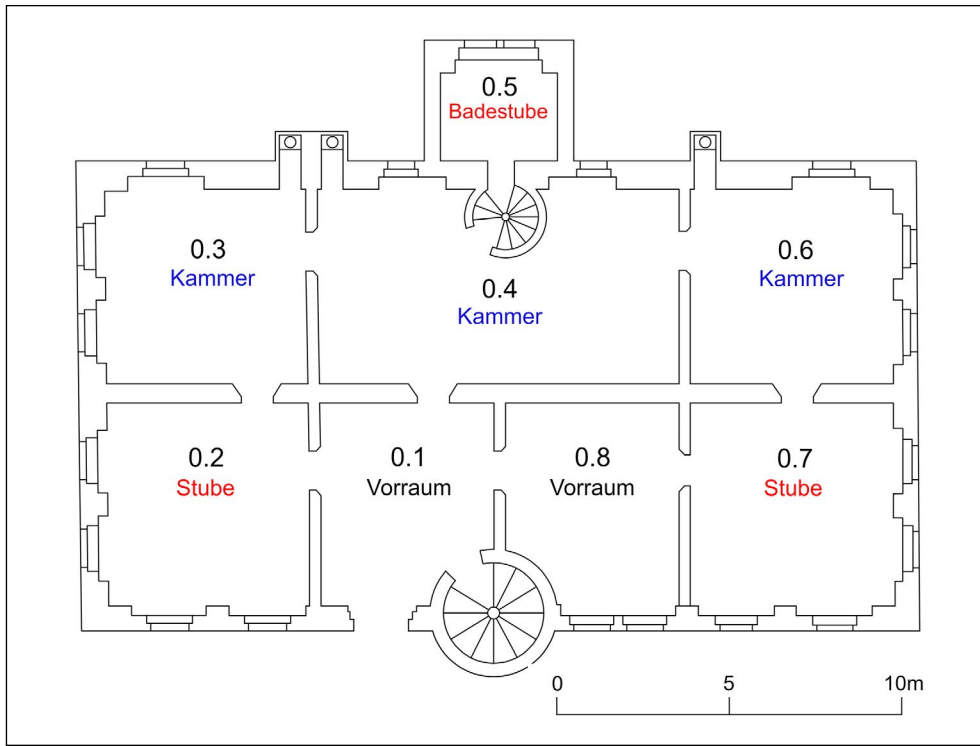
Jessen (Elster), Schloss Glücksburg, Erdgeschoss, Grundriss, Rekonstruktion des Baubestands und der Raumfunktionen um 1600–1641
